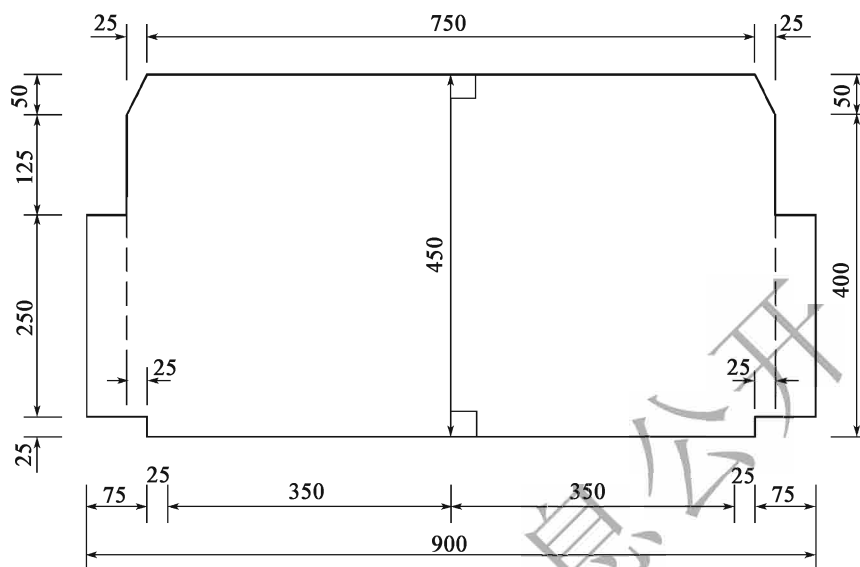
Dégagement de construction du tunnel routier de troisième classe à deux voies (40km/h) (unité:cm)
